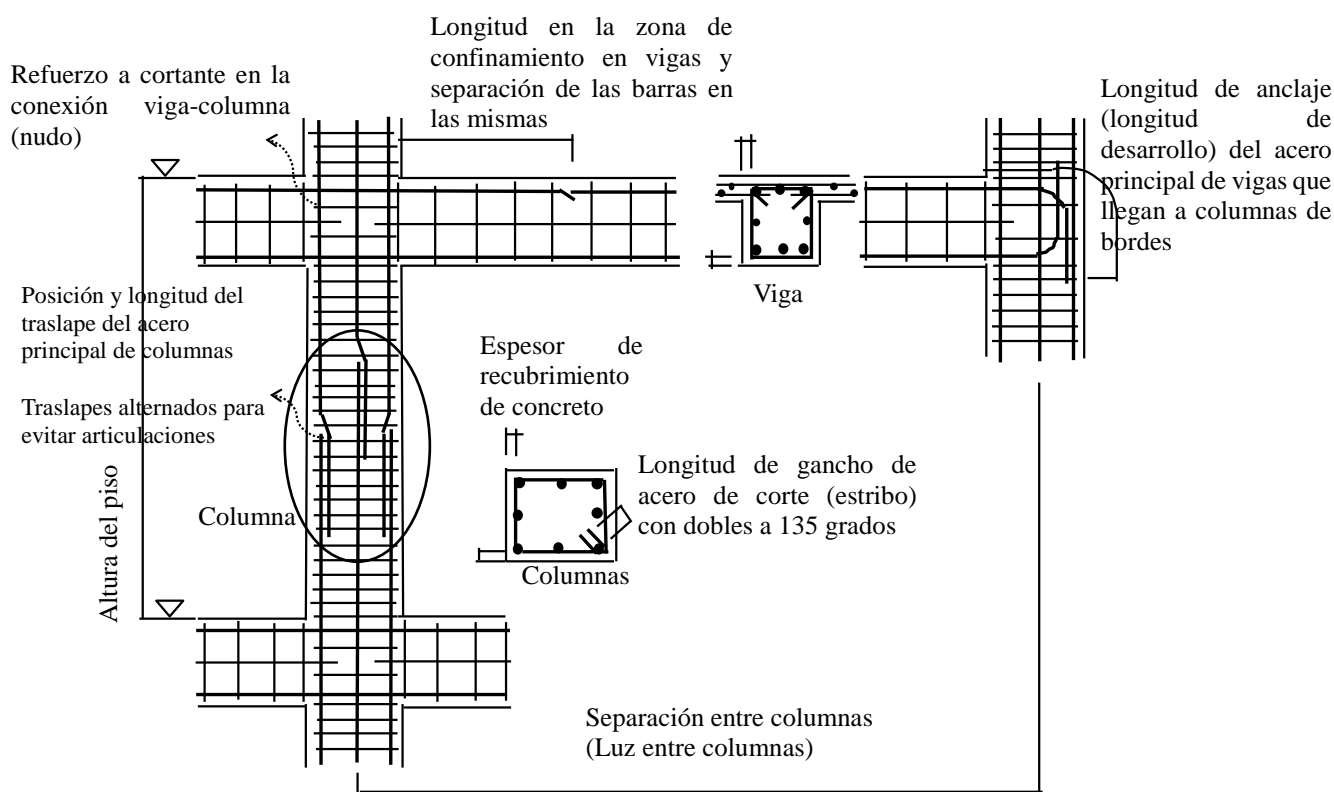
Información que se mostrará para el detalle de las varillas de refuerzo para viga y columna
